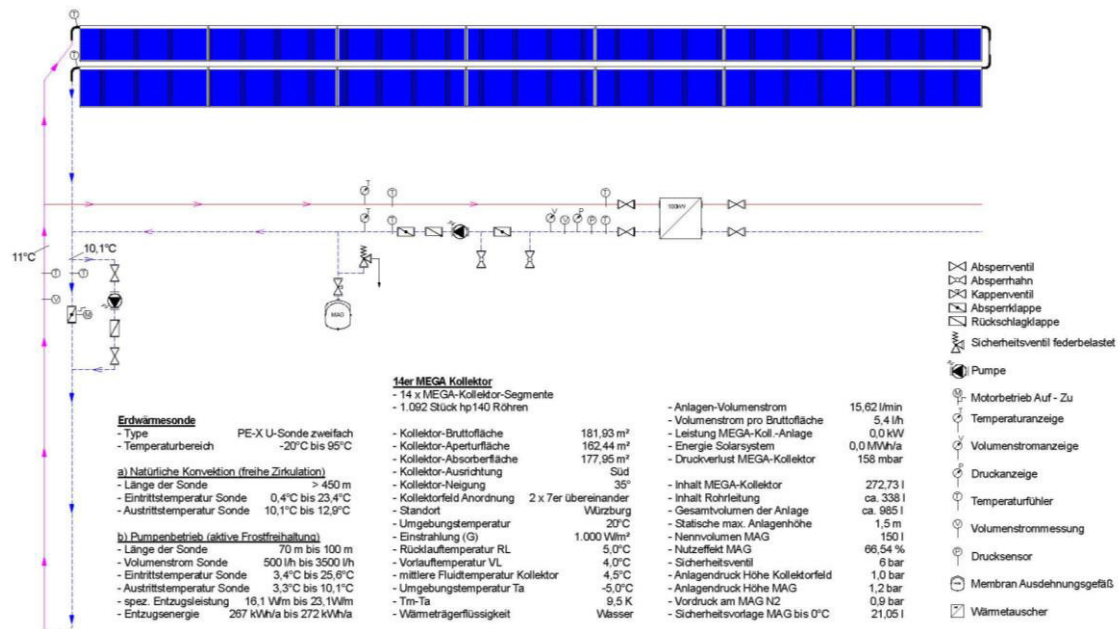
Kollektoranlage mit Erdwärmesonde
